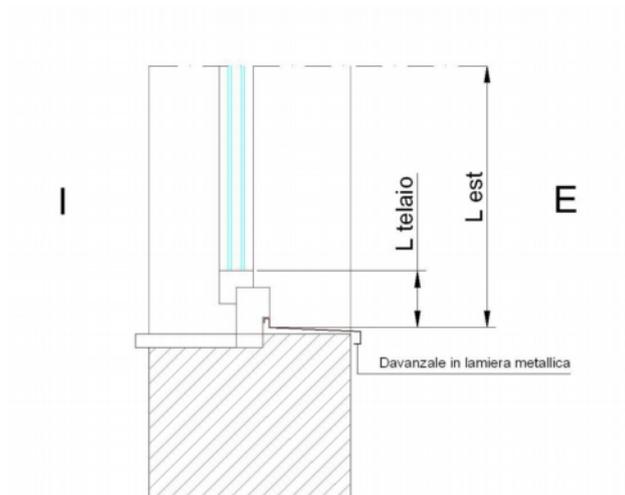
Sezione verticale, attacco inferiore con davanzale in lamiera metallica
